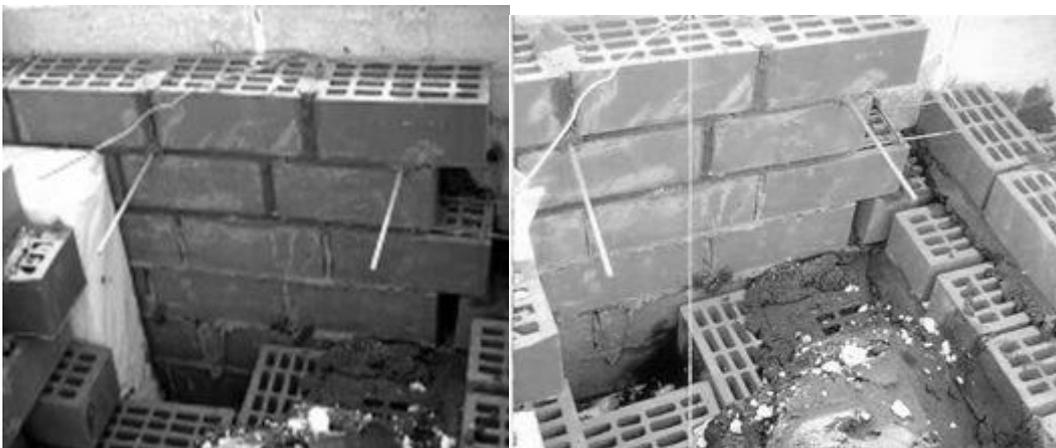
Фрагменты кирпичной кладки стены с установкой «гибких связей» из АНК в швах кладки
